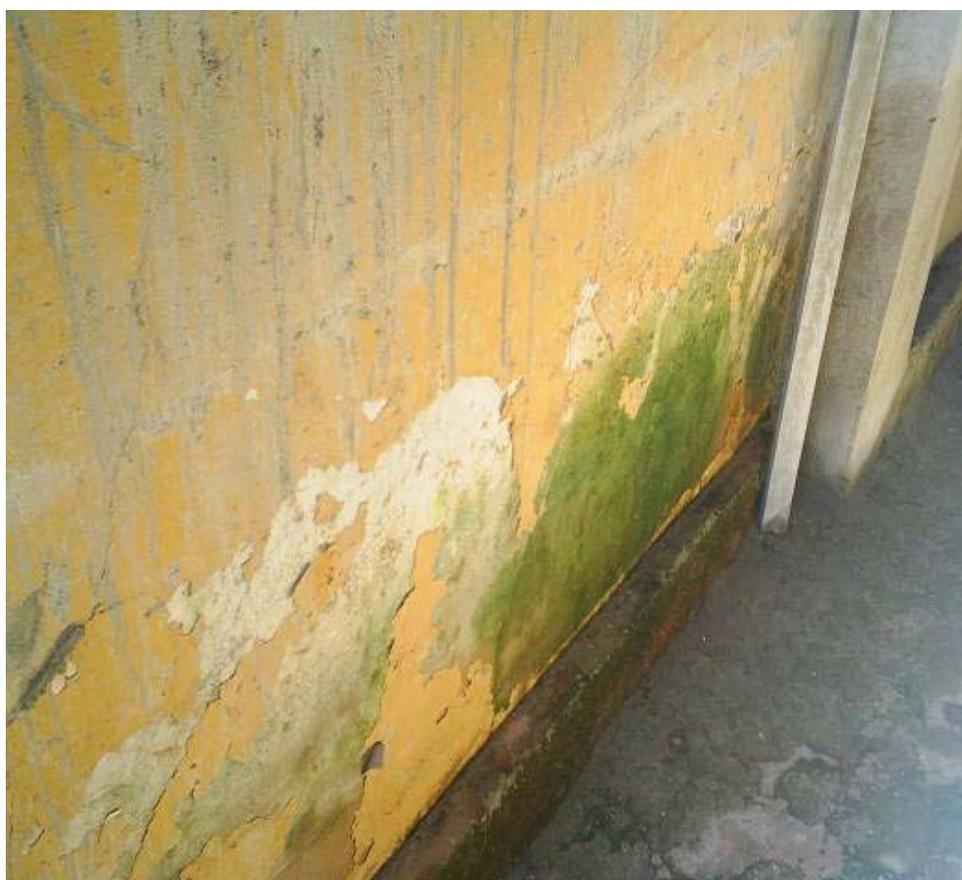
Parede da casa adjacente ao muro de divisa.
